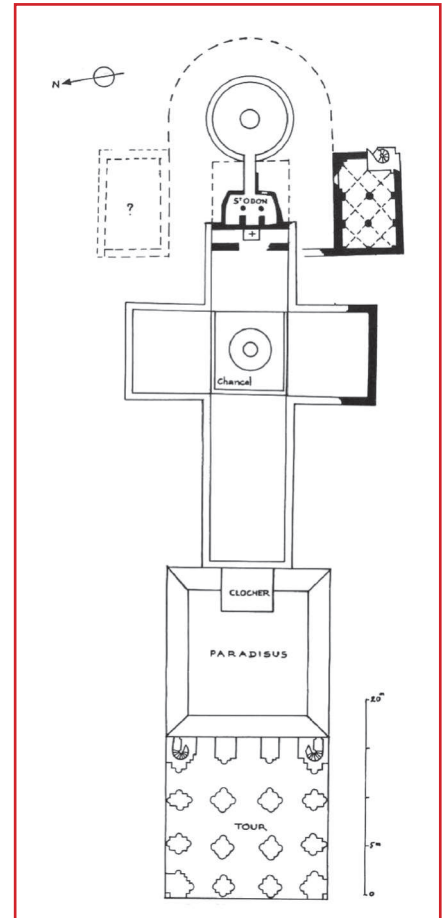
Saint-Benoît de Fleury, Grundriss-Rekonstruktion (Berland)
